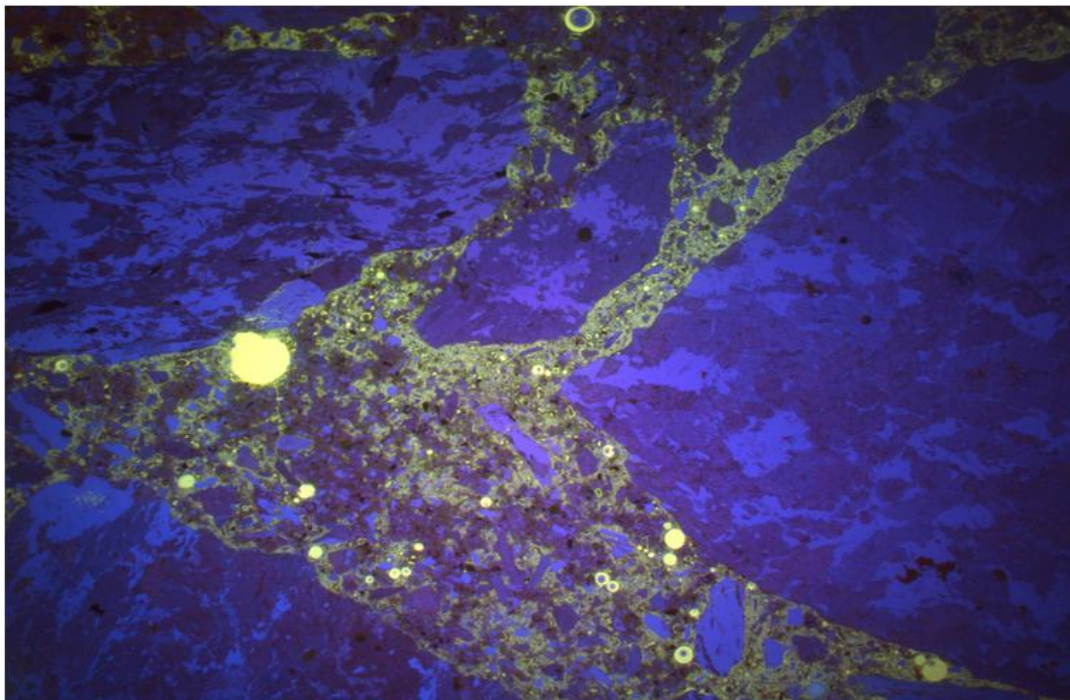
Prov H1, från Håckren. Planslip belyst med UV ljus. Närbild på betongens yttre del. Området i bilden är ca 60 mm brett.
